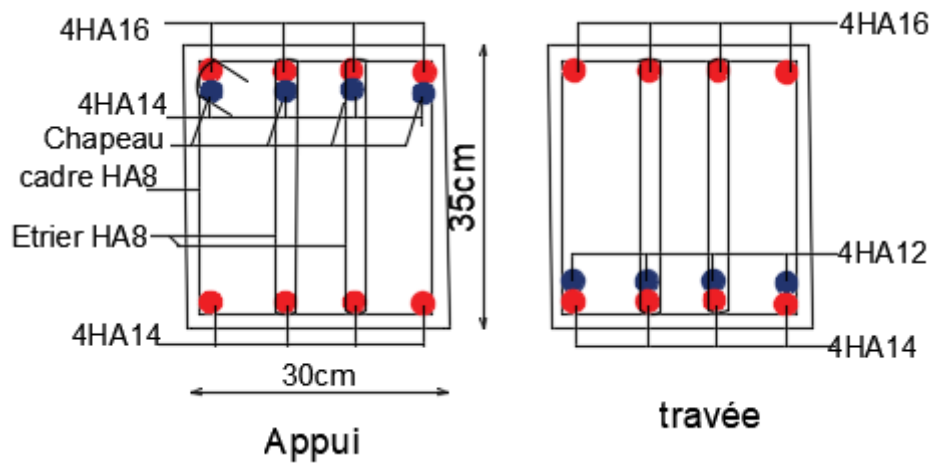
Schéma de ferrailage de la poutre secondaire du plancher étage 6
